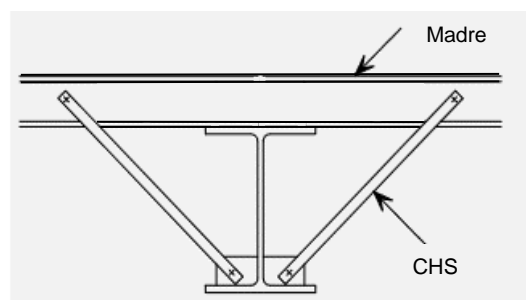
Travamento do banzo inferior das vigas IPE. Adaptado de [1].
